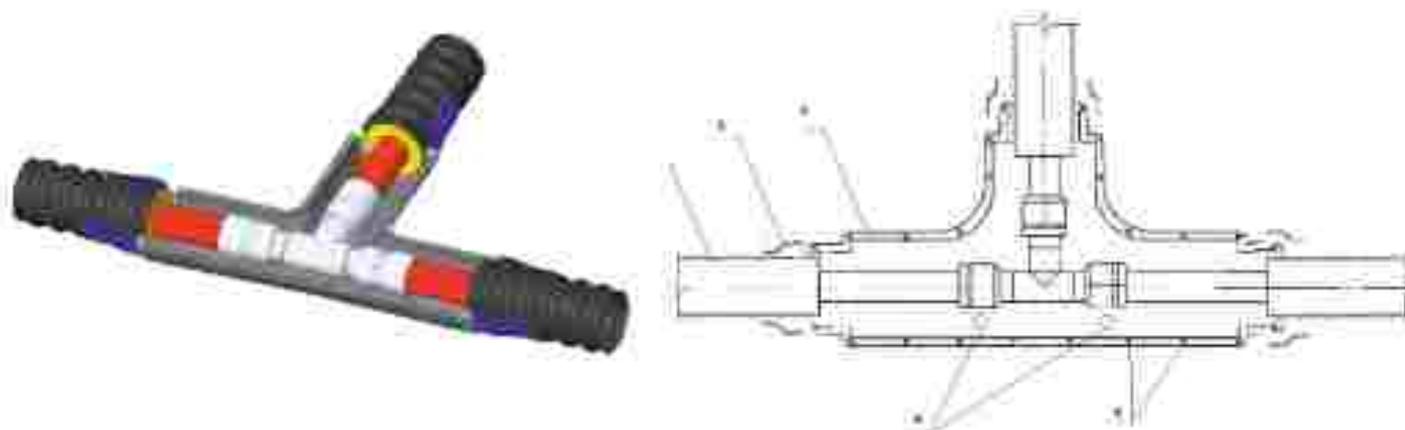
Конструкция стыкового соединения с защитным полимерным кожухом.
